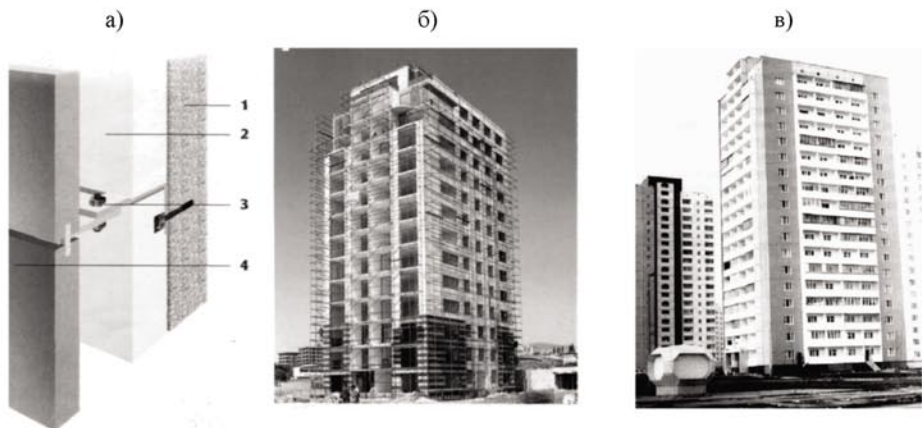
Вентилируемый фасад: а) схема стены (слева): 1 — наружная стена здания; 2 — утеплитель Pol rap и воздушный промежуток; 3 — профильная система подвески; 4 — фасадная система из керамических плиток; б) процесс монтажа (в центре); в) пример устройства вентилируемого фасада при реконструкции здания (справа): фасад панельного жилого дома № 48-Б в Киеве (массив "Осокорки") после реконструкции и утепления с использованием системы "ABP"
